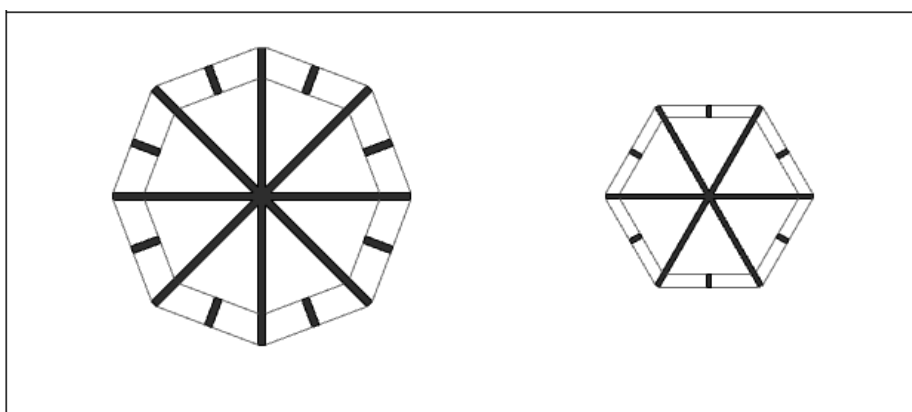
Planta típica de torre de ocho y seis lados. Elaboración propia (Roaf, 1988)
